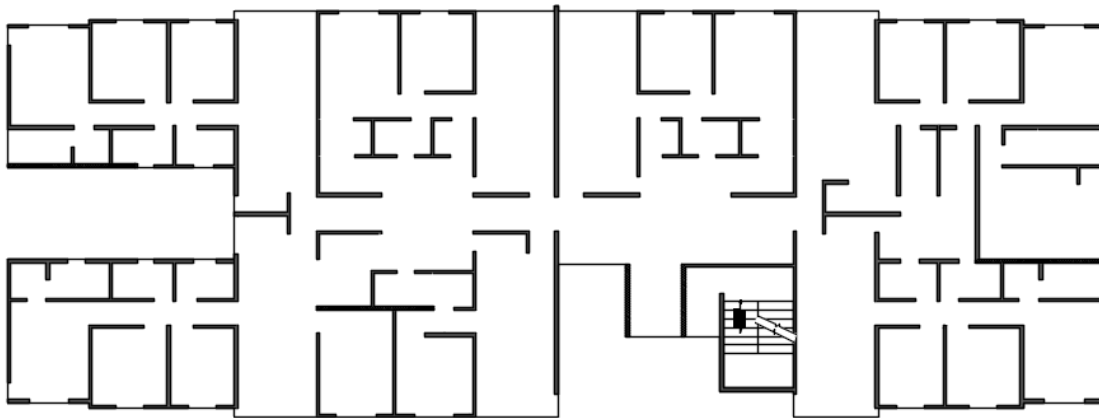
Planta típica de muros. Fuente: Imágenes de planos DUAL INGENIERÍA ESTRUCTURAL SAS. Archivo personal, recuperado en el 2017.
